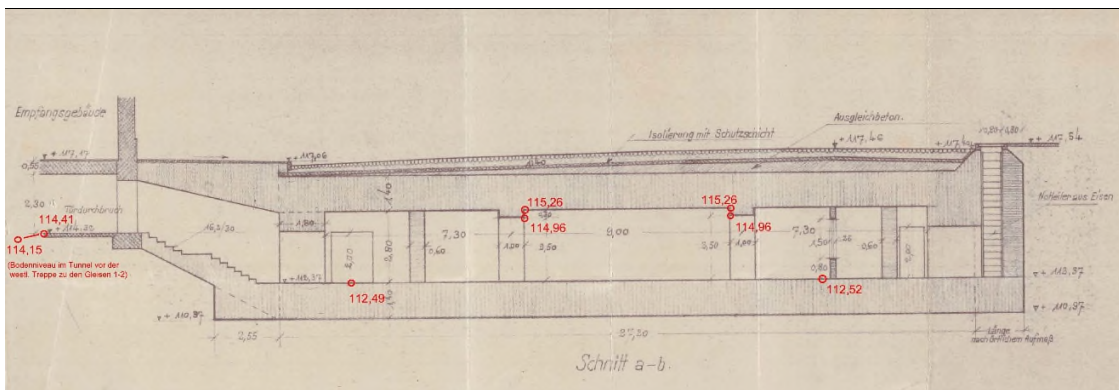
Querschnitt Grundriss rechtwinklig zum Bahnhofsgebäude
